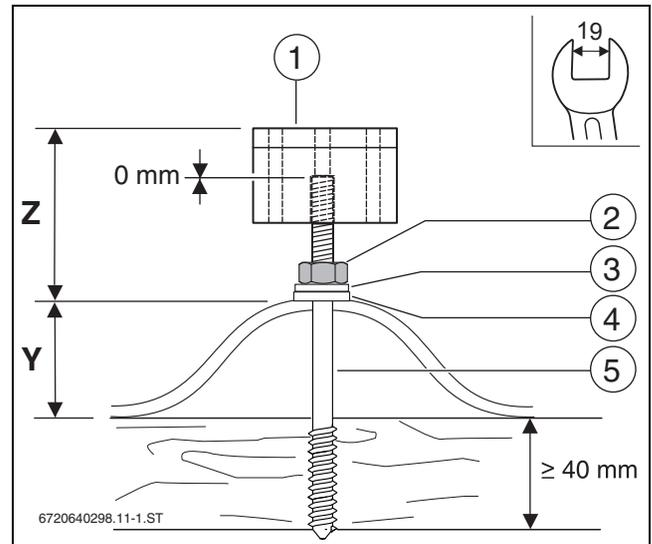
Tornillo de doble rosca montado con caballete de soporte
